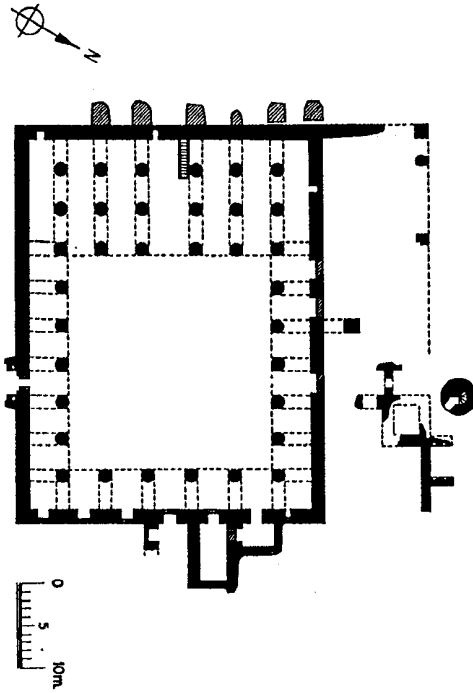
مسقط أفقي لجامع القيروان بتونس (عن : Lezine)
